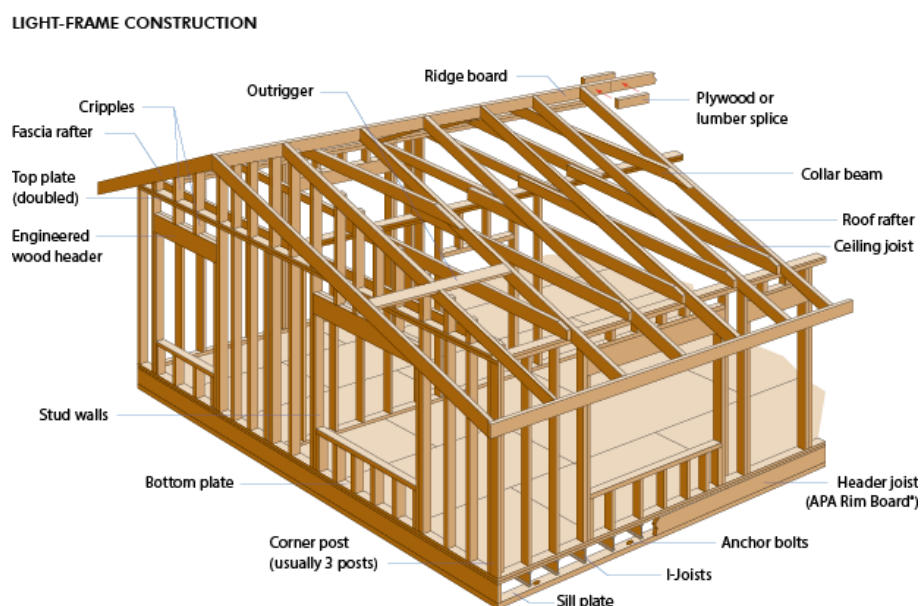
Estructura de casa prefabricada de madera. Fuente: Empresa Maderas Casais.
